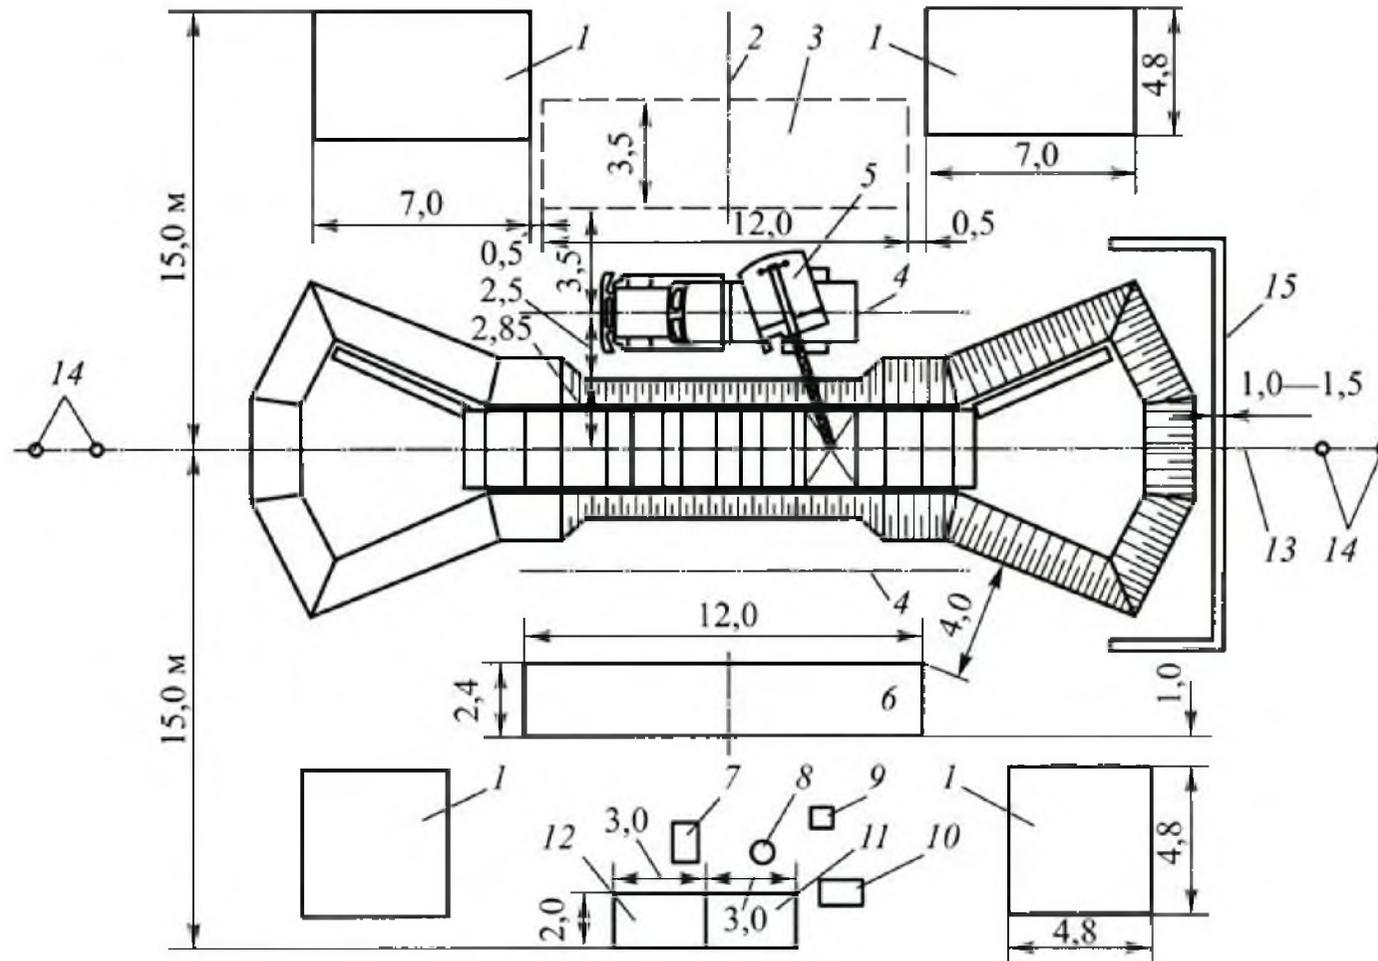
План строительной площадки сборной железобетонной трубы:
